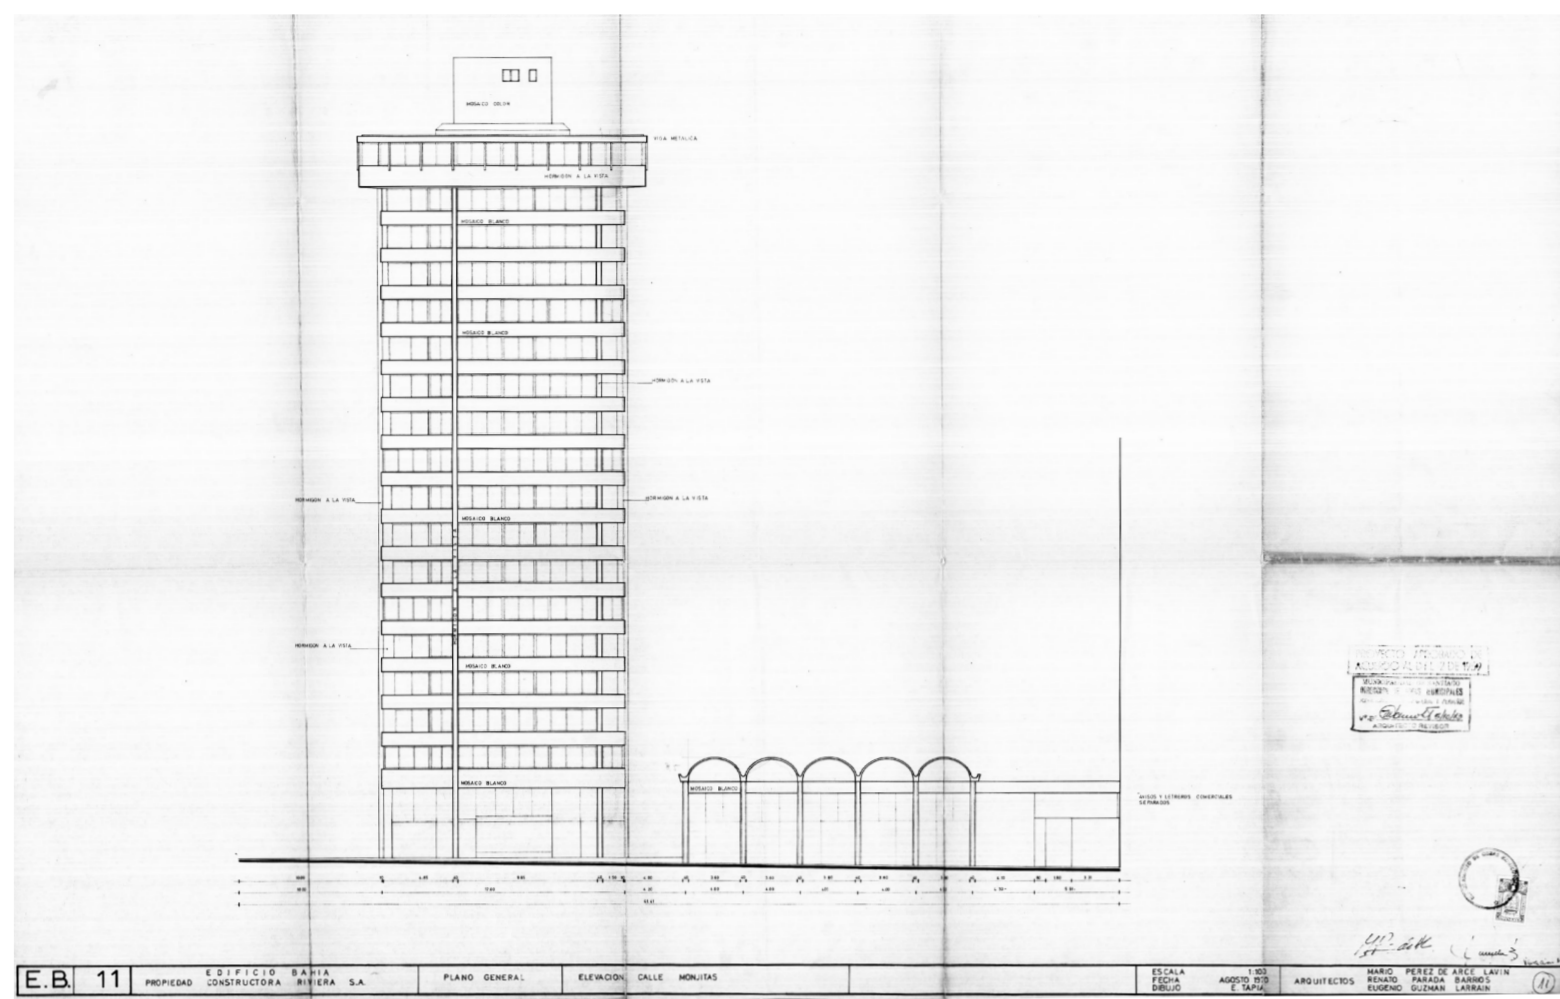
Archivo Plano Municipal. Vista calle monjitas.
